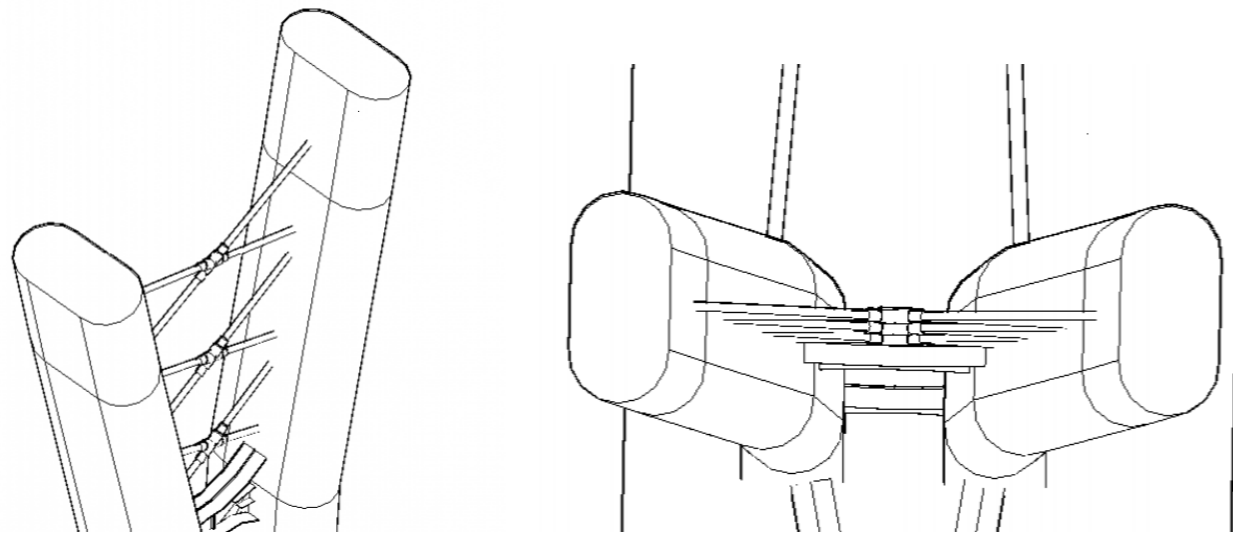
Vista de la sección 3D (en estructura alámbrica) de las torres de la pasarela. Fuente: Elaboración Propia (AutoCAD)
